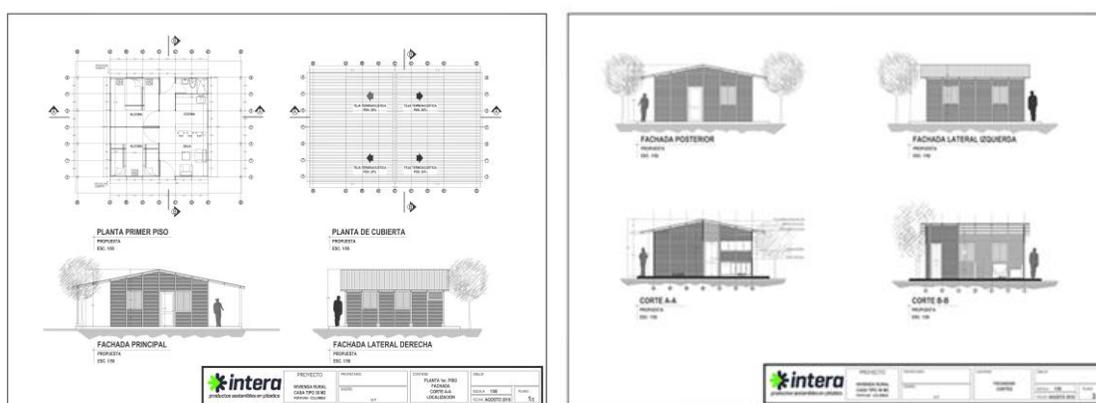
Planta Distribución Vivienda Rural 36 m<sup>2</sup> Con Corredor. Fuente: Elaboración propia.
